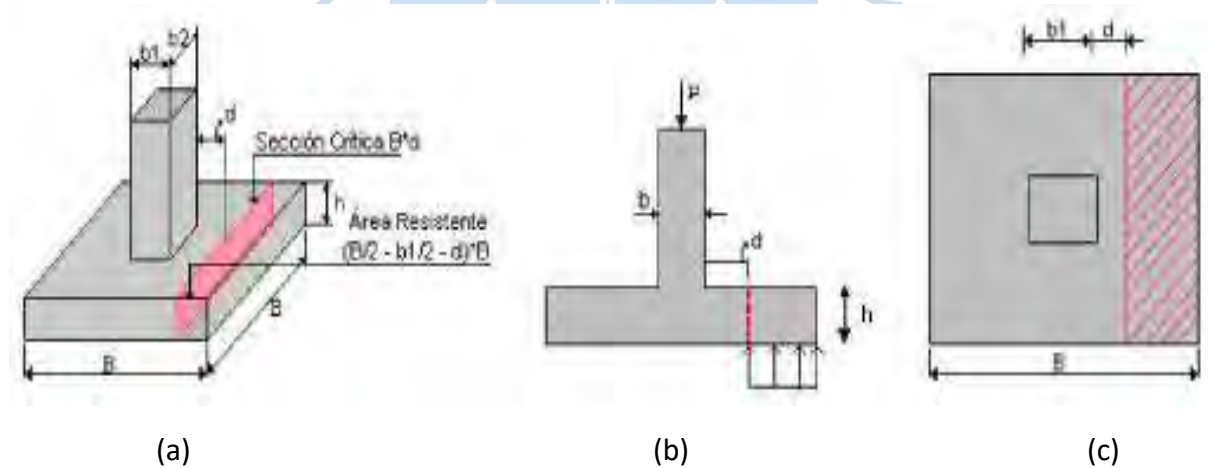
Aplastamiento en zapatas aisladas (a) modelo geométrico, (b) modelo estructural de la verificación del aplastamiento
